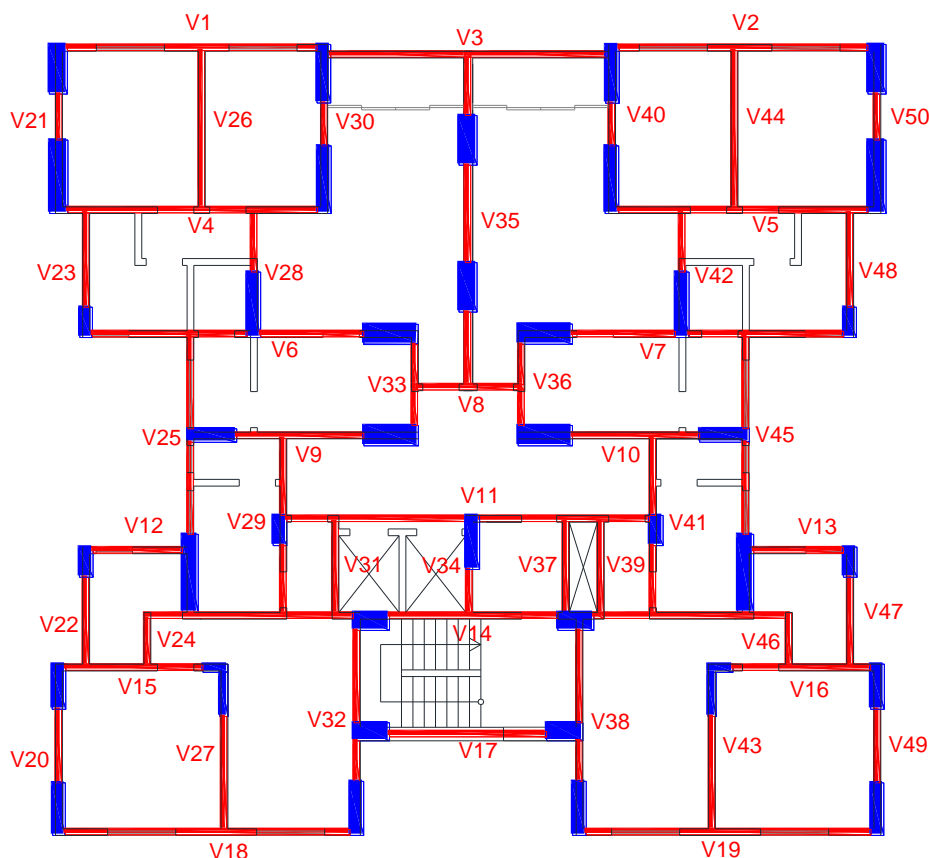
Localização dos pilares e das vigas em concreto armado – Residencial Navarro.
